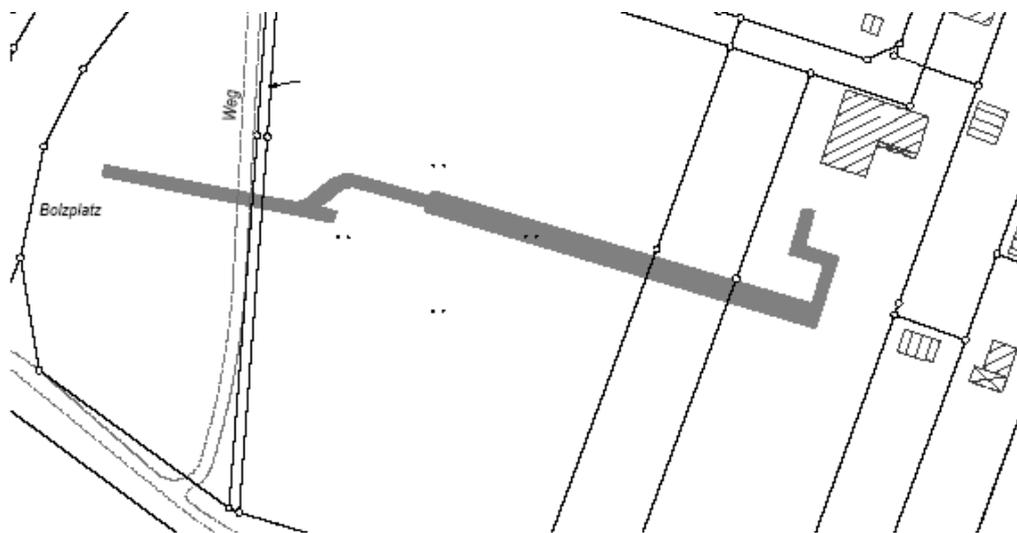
Lageplan Luftschutzstollen STEINKUHLE
